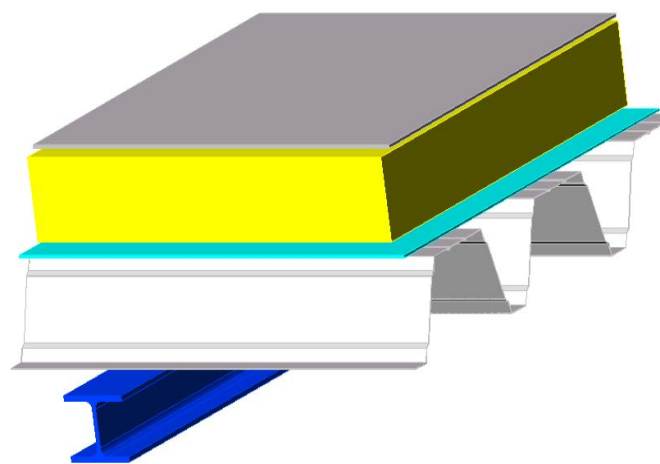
Wärmegedämmtes unbelüftetes Foliendach
